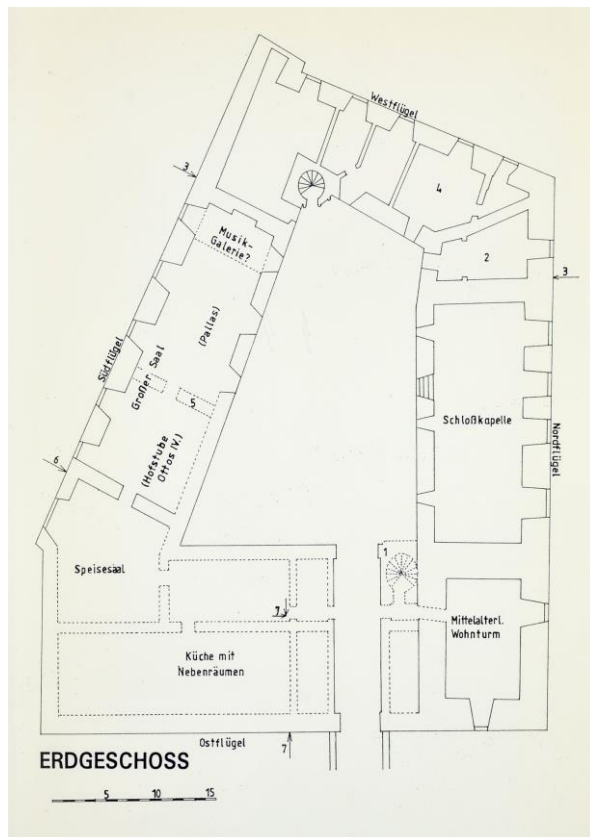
Grundriss Erdgeschoss, Raumverteilung aus dem frühen 17. Jahrhundert, aus: Borggrefe 1994
